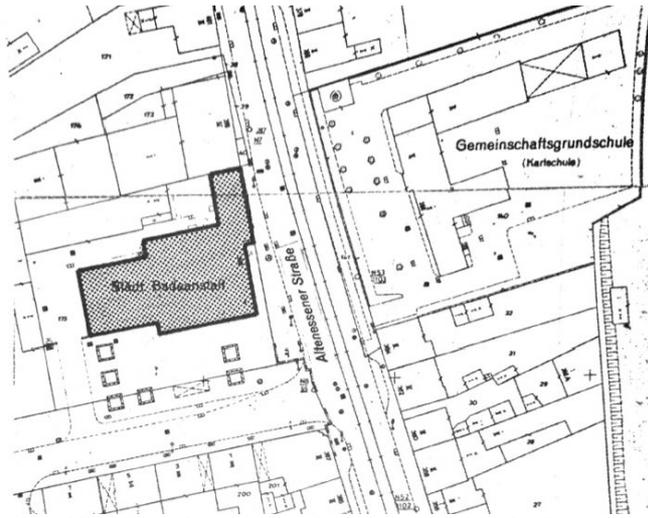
1 Lageplan des Baudenkmals „Stadtbad Altenessen“, Essen-Altenessen, 1987 (aus: Denkmalliste der Stadt Essen, Karteikarte zum Baudenkmal 223. Lageplan in der Fassung vom 12.11.1987)
